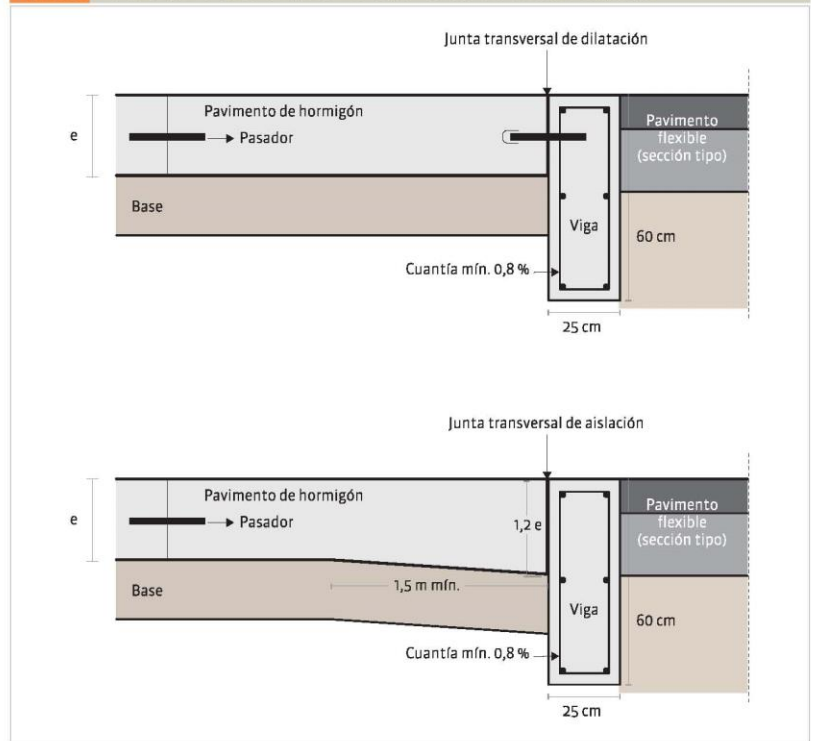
Transición pavimento de hormigón con flexible, con elevado volumen de tránsito pesado.
